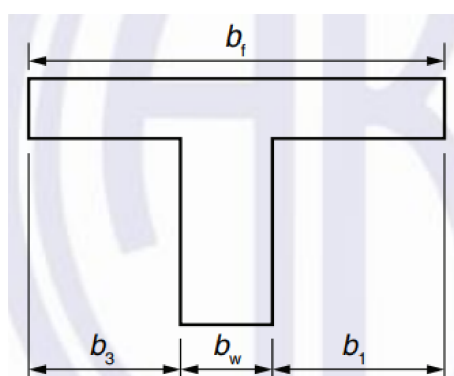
Seção simples da viga V12 do pavimento 1º Andar
